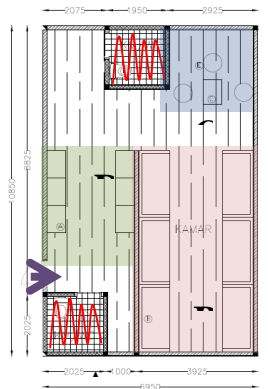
Gambar Denah Layout Ruang Terpilih 2
